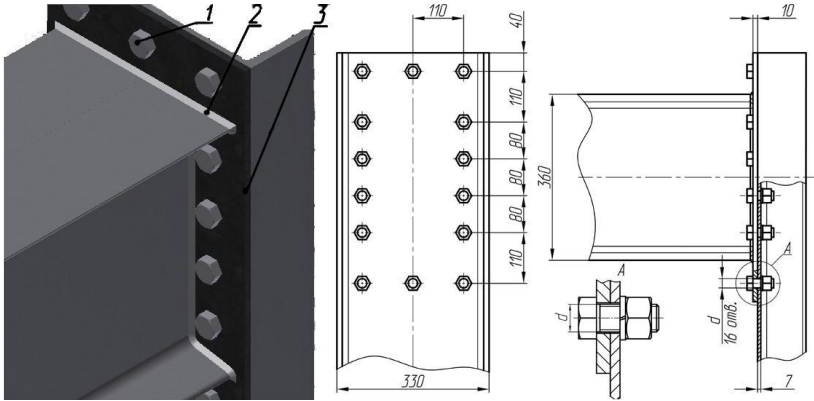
Расчётная схема продольной и поперечной балок:
